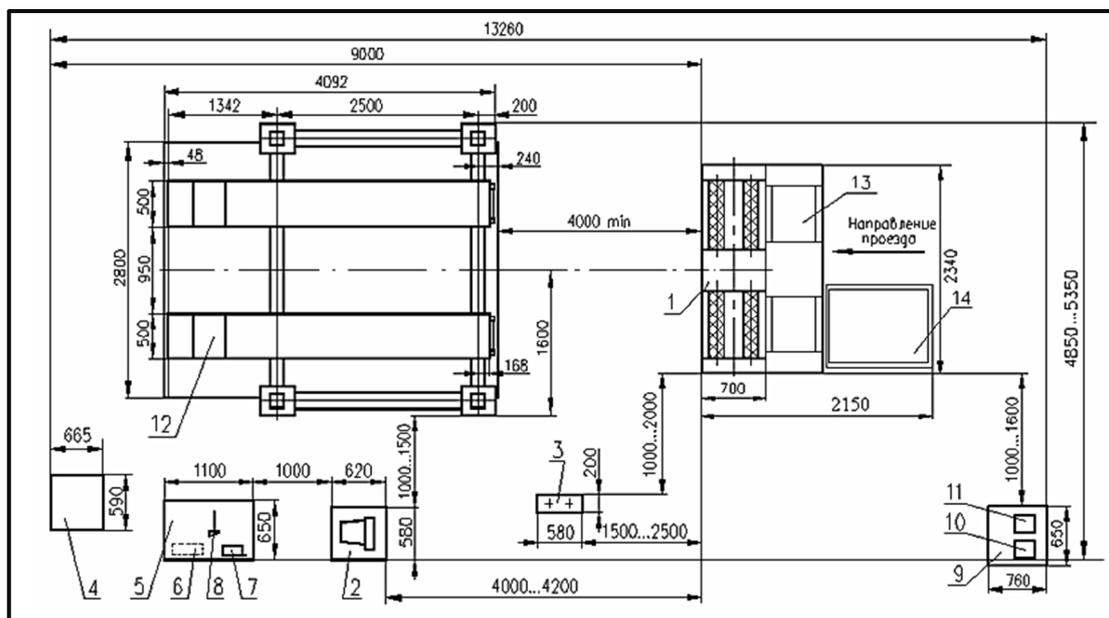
Планировка размещения оборудования линии в рабочем положении с подъемником П178: 1 - устройство опорное Стенд Тормозной Силовой; 2 – стойка приборная СТС; 3 – шкаф силовой СТС; 4 – прибор проверки фар; 5 – стойка приборная СП-4; 6 – измеритель люфта; 7 – прибор проверки прозрачности стекол; 8 – штангенциркуль; 9 – стойка приборная СП-3; 10 – газоанализатор; 11 – измеритель дымности; 12 – подъемник; 13 – тестер подвески; 14 – тестер увода.
